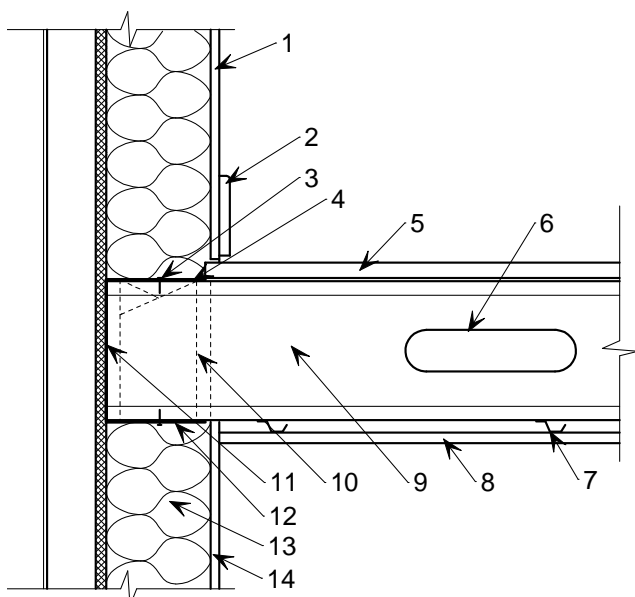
Montaż prefabrykowanego elementu stropowego (Źródło: Lindab Profil AB)
